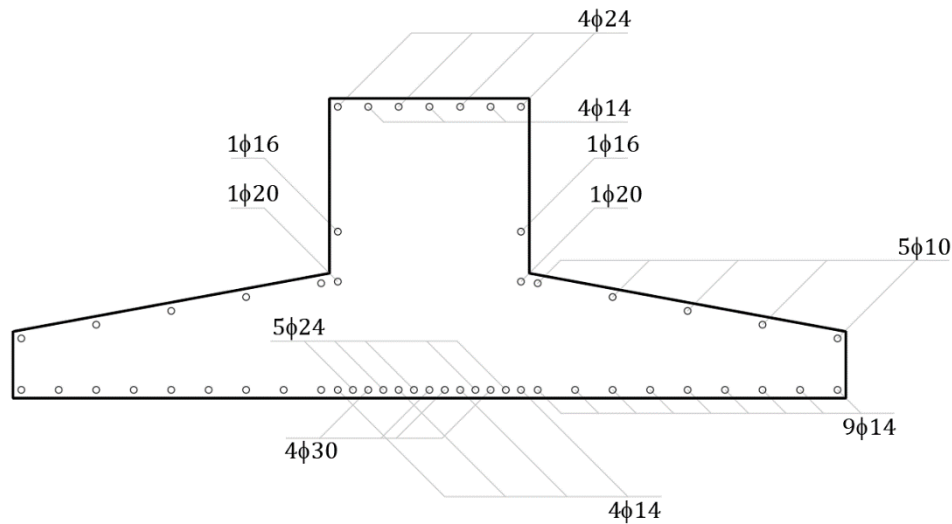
Dettaglio plinto cavalcavia 312 - Sezione trasversale
